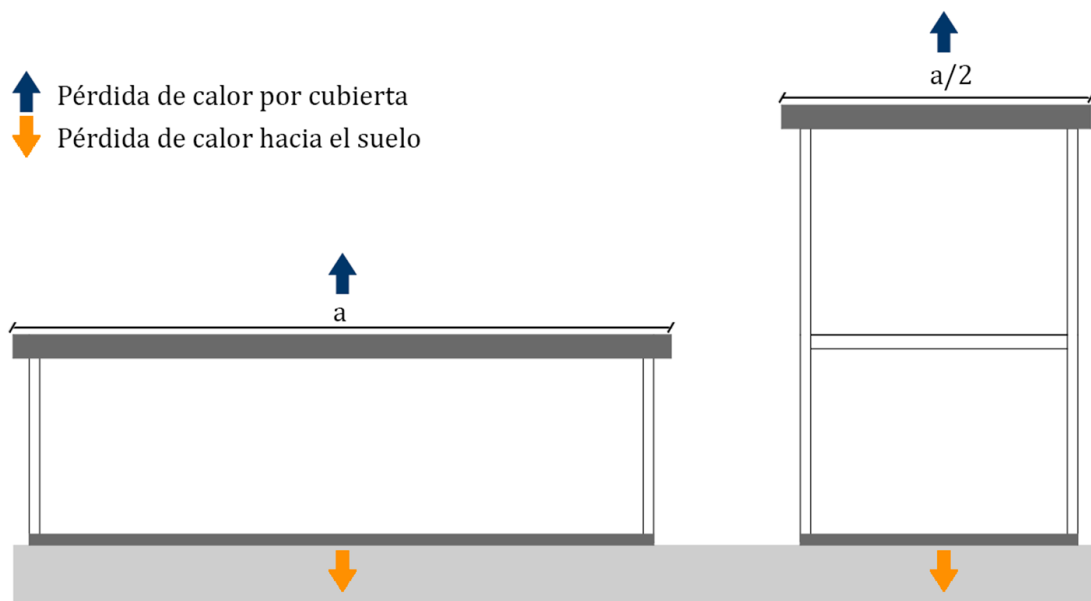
Pérdidas de calor generadas en una vivienda de una planta y una vivienda de dos plantas.
